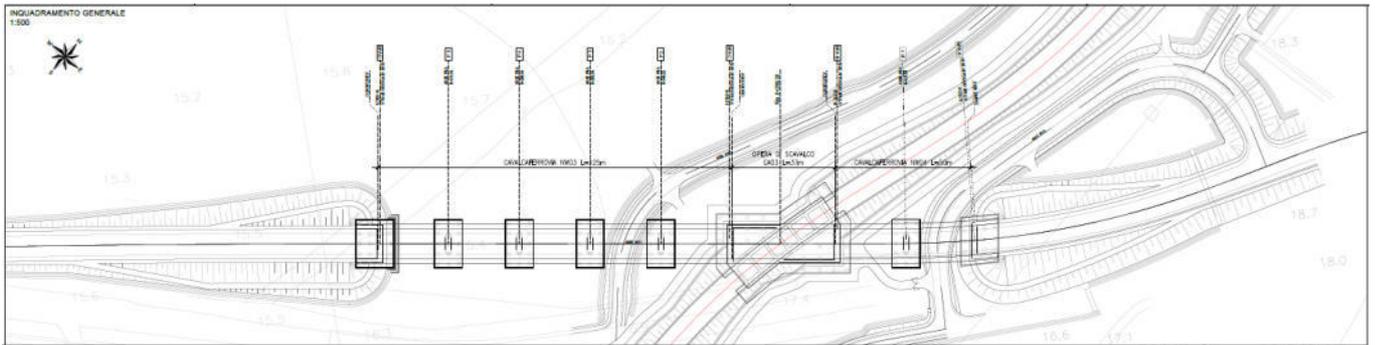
Pianta del viadotto stradale NW03-NW04
